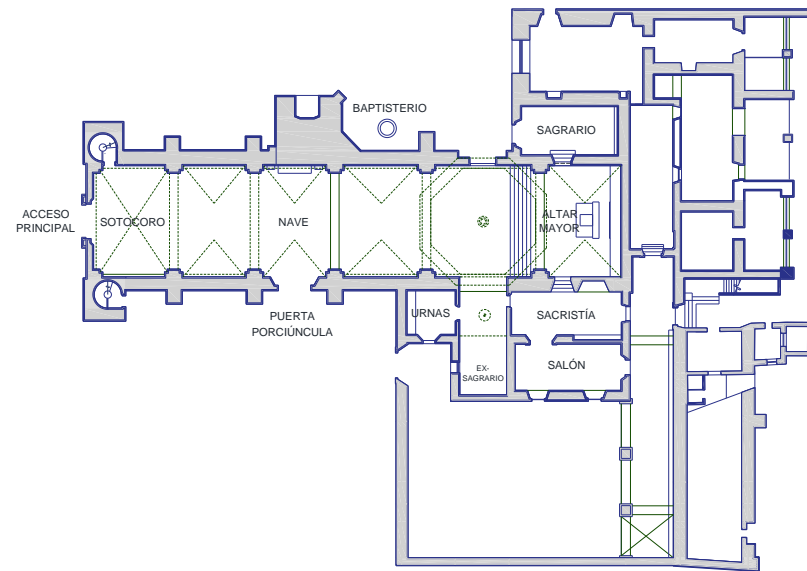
Planta Baja Arquitectónica del Templo de San Juan Evangelista, Xochitepec, Morelos. Fotografía Colaboración entre el Autor y Angélica Itzel Nava Galindo. Año 2018.
